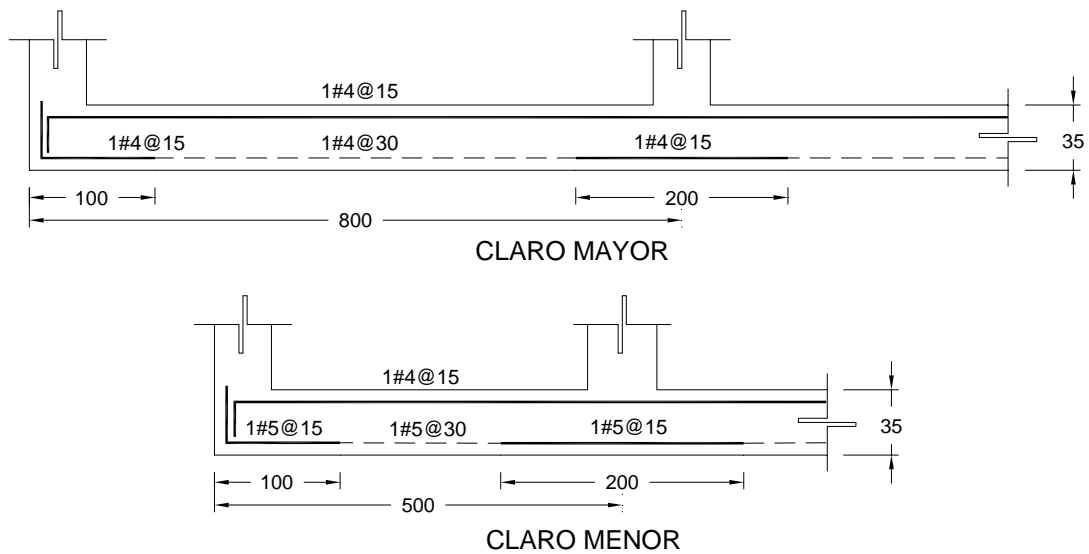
Armado de losa de cimentación en ambos sentidos
